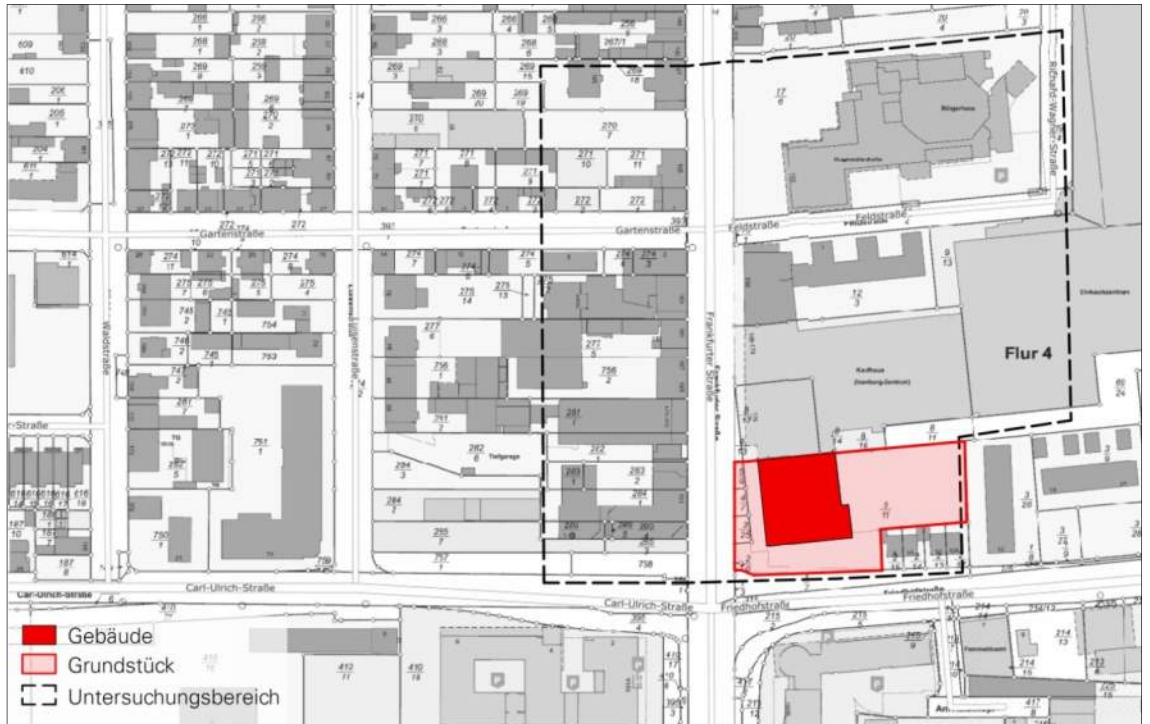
Lageplan, Maßstab 1:2000 (Eigene Darstellung / Kartengrundlage: Katasterplan Stadt Neu-Isenburg, Stand M 2019)
